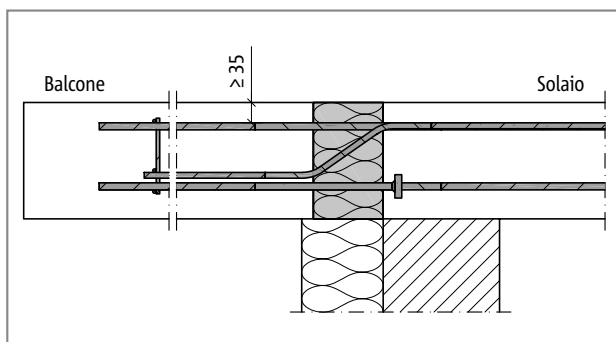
Schöck Isokorb® tipo EXT-CV35: raccordo con sistema di isolamento a cappotto (WDVS)
